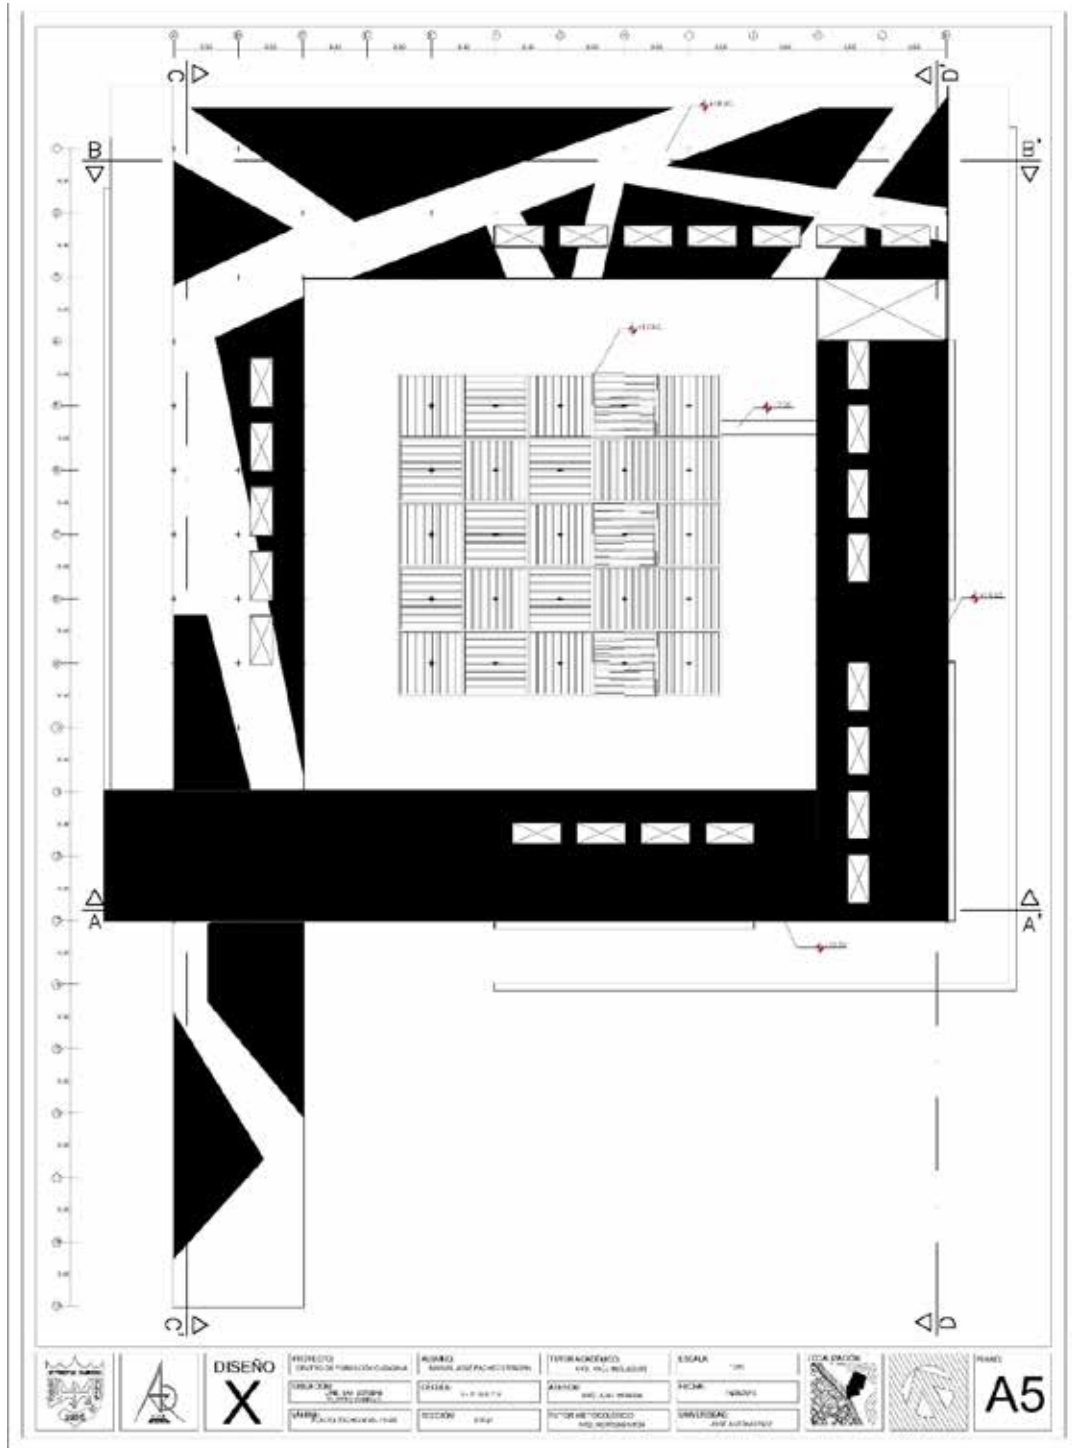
Planta Techo. Fuente: Propia autoría. (2018).
